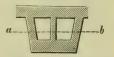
Grundriß nach of. Doppel-Schachtofen.
